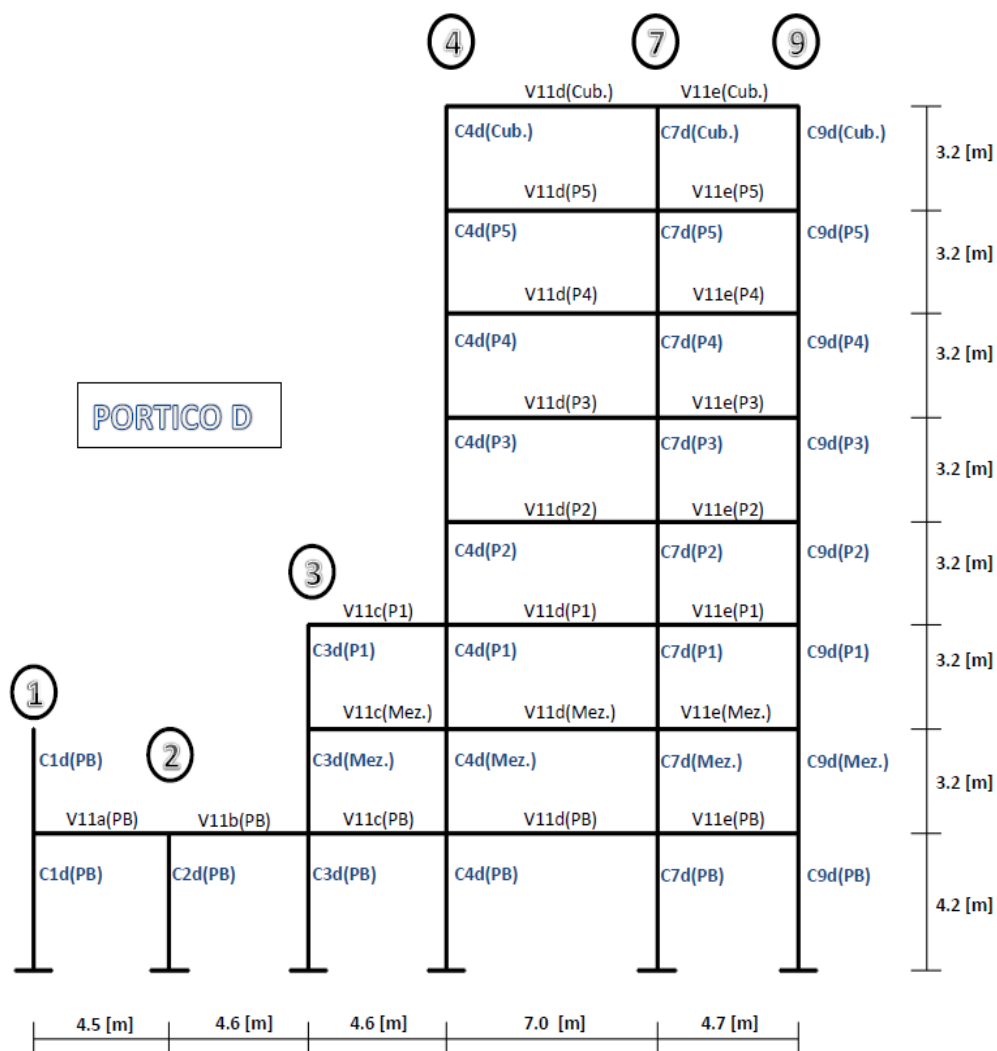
Asignaciones en vigas y columnas del pórtico D.
